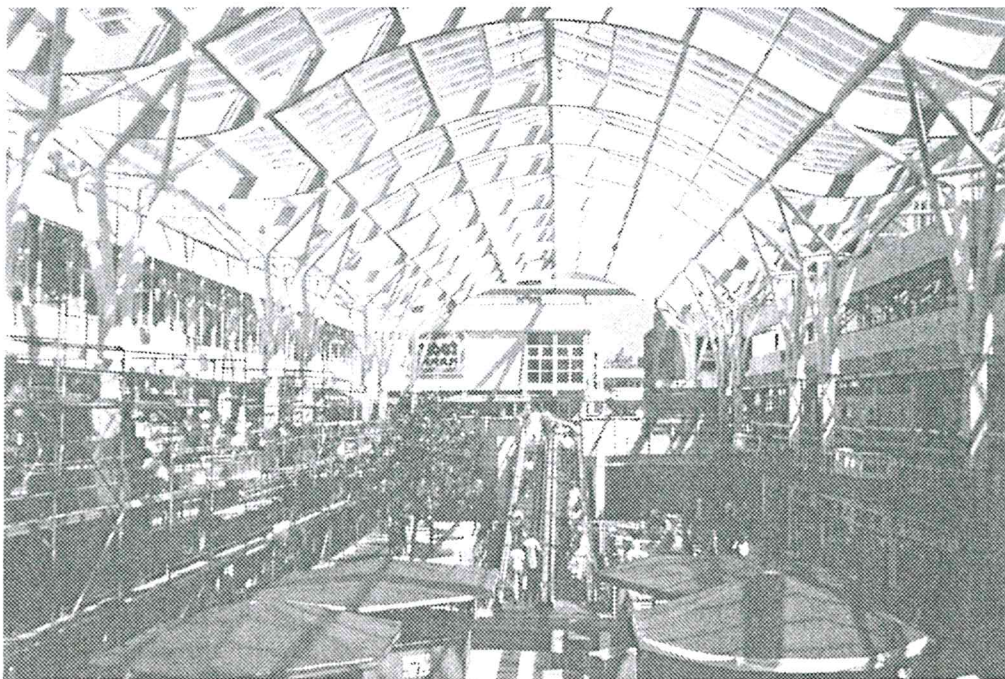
Überdachung einer Einkaufspassage in Frankfurt/Main
